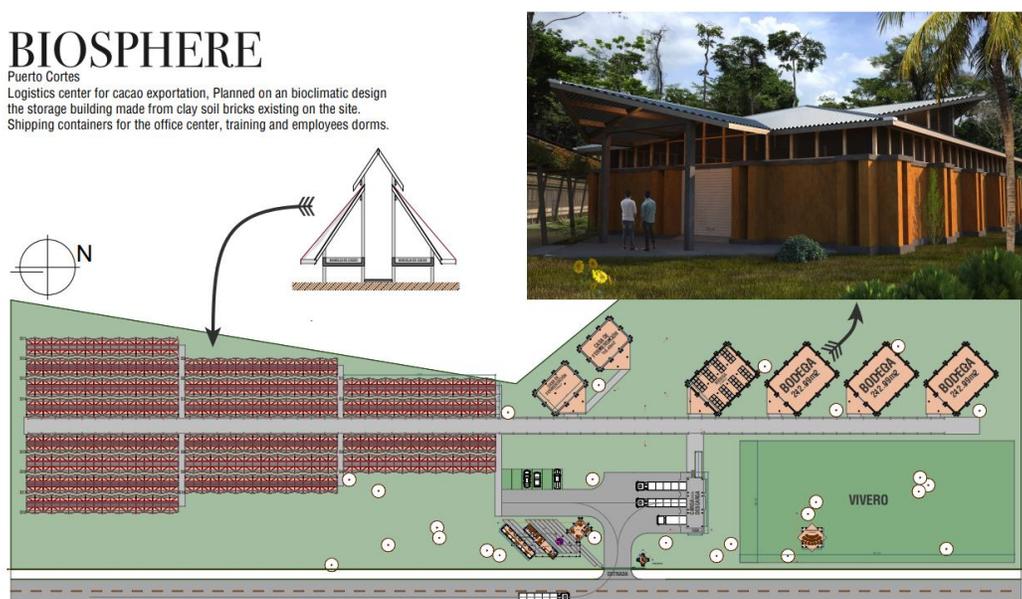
Planta arquitectónica del centro logístico Biosphere.
